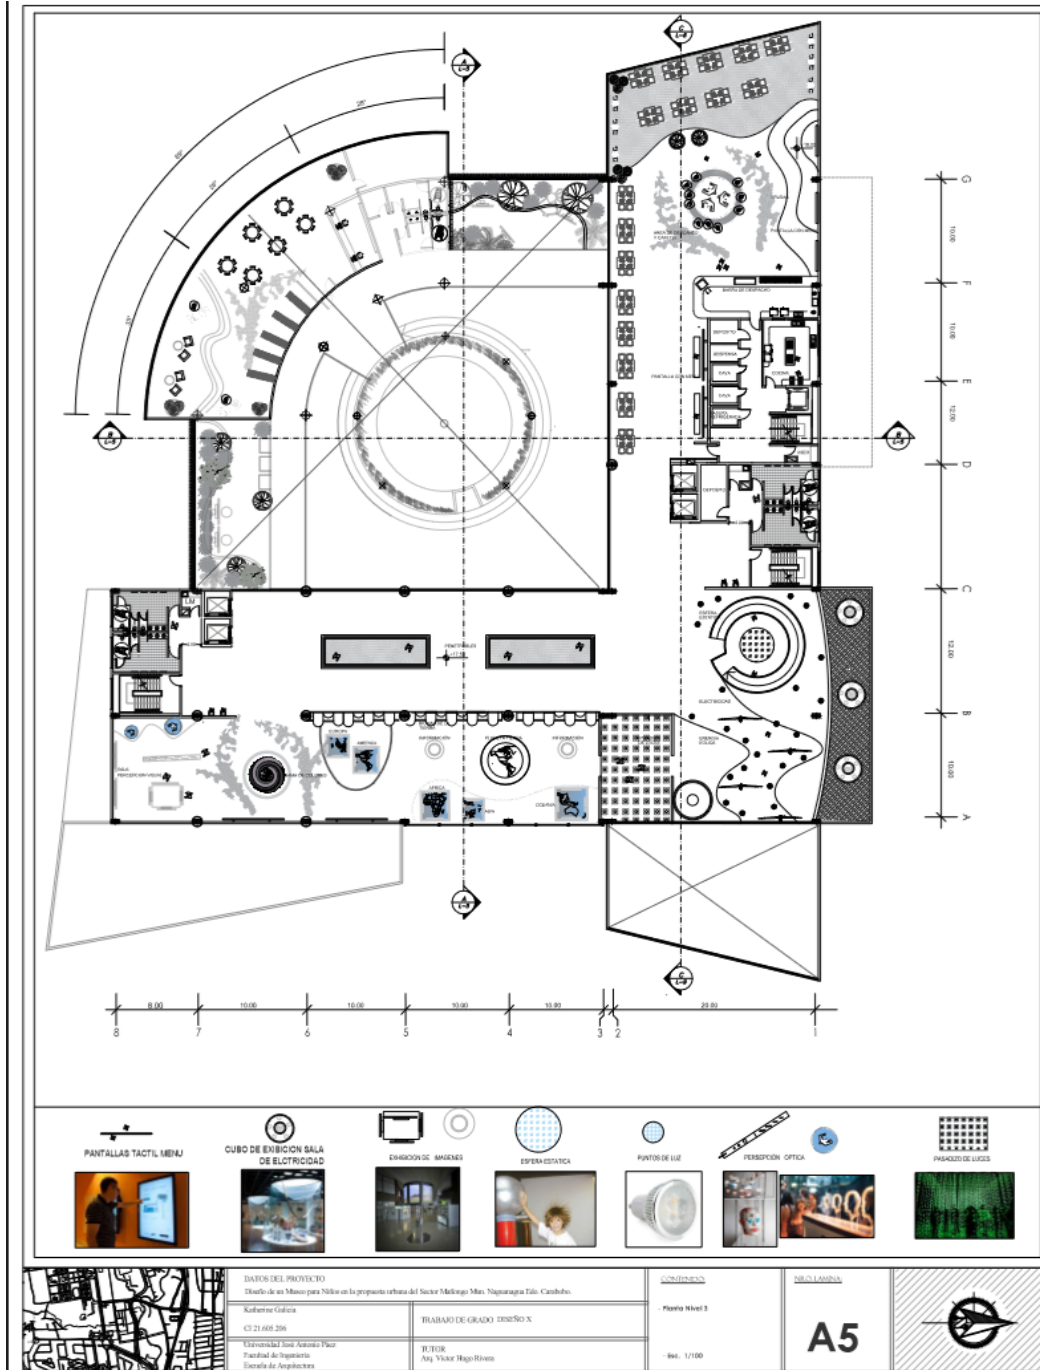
Planta Nivel 3 A-5. La Autora (2015)
